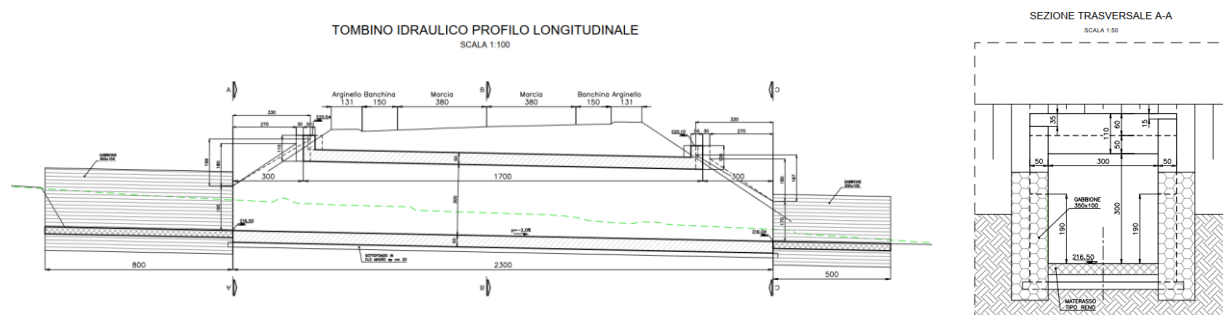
Tombino scatolare (sezione longitudinale e prospetto imbocco)
